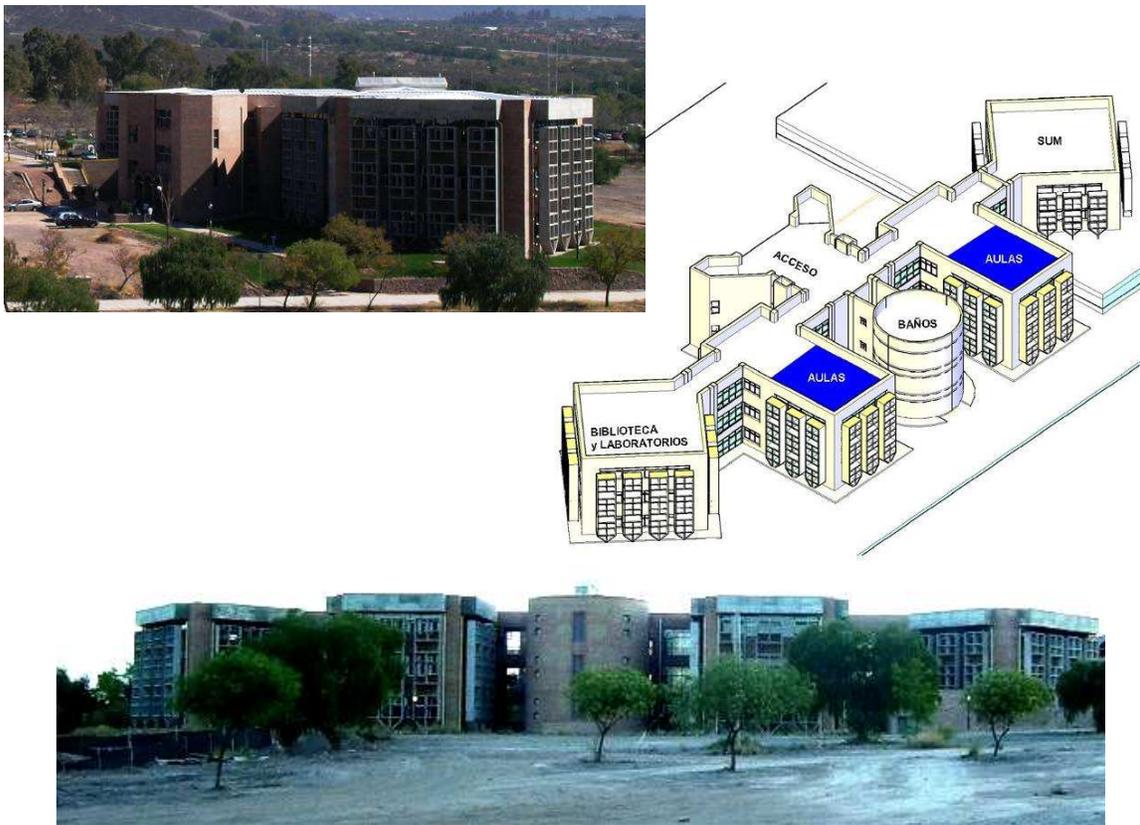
Fotos Acceso (arb. Izq.), dibujo de axonometría edificio (azul: bloques aulas) y foto fachada Norte (inferior).
